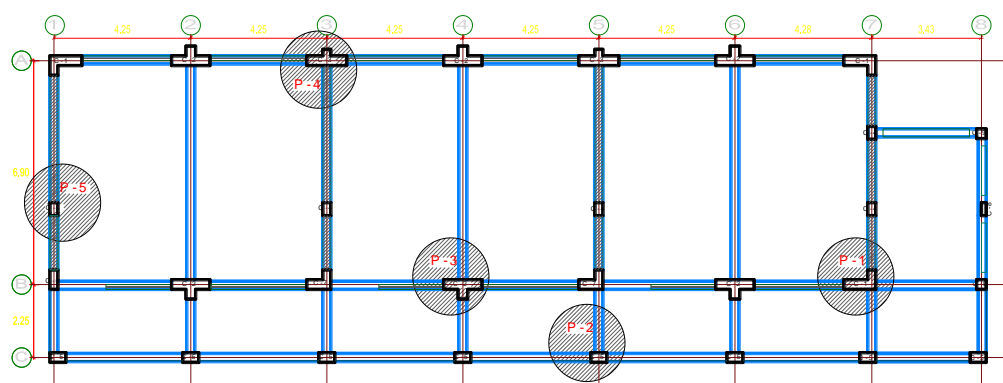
Ubicación de la prueba de rebote para las Columnas.
